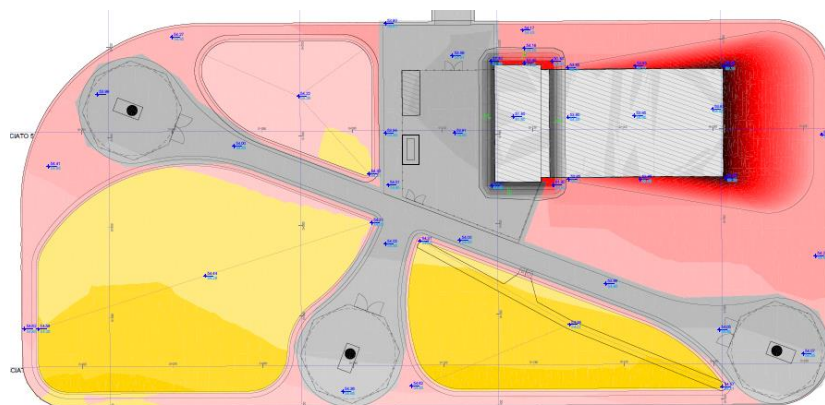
Planimetria fase 2 movimenti terra con indicazione in giallo delle arre soggette a scavo per realizzazione depressioni terreno, e in rosso i rinterri e rilevati.
